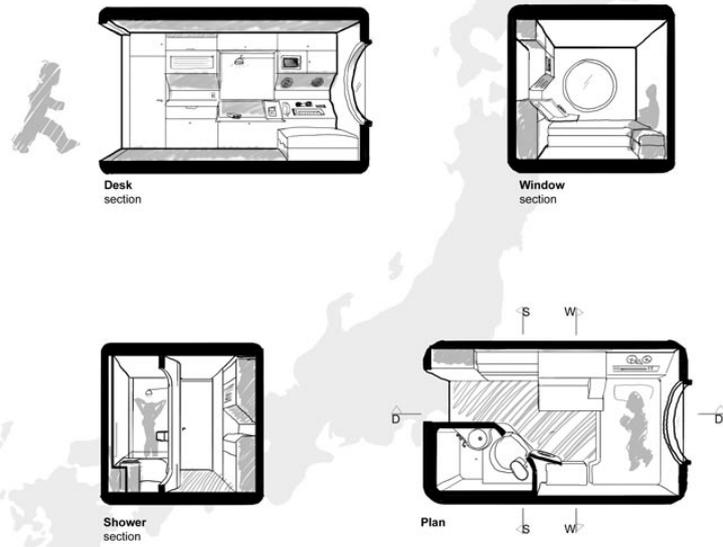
Grundriss und Capsules, Nakagin Capsule Tower
